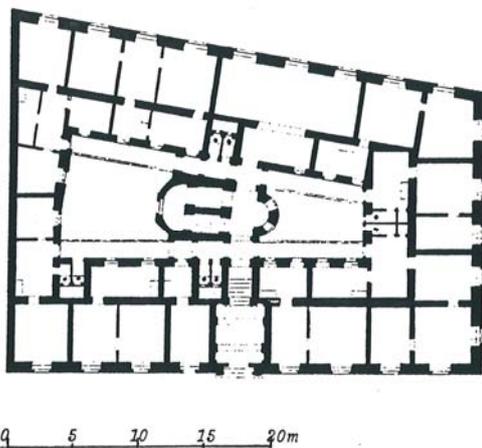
Grundriss Rudolfshof, Wien (l)
